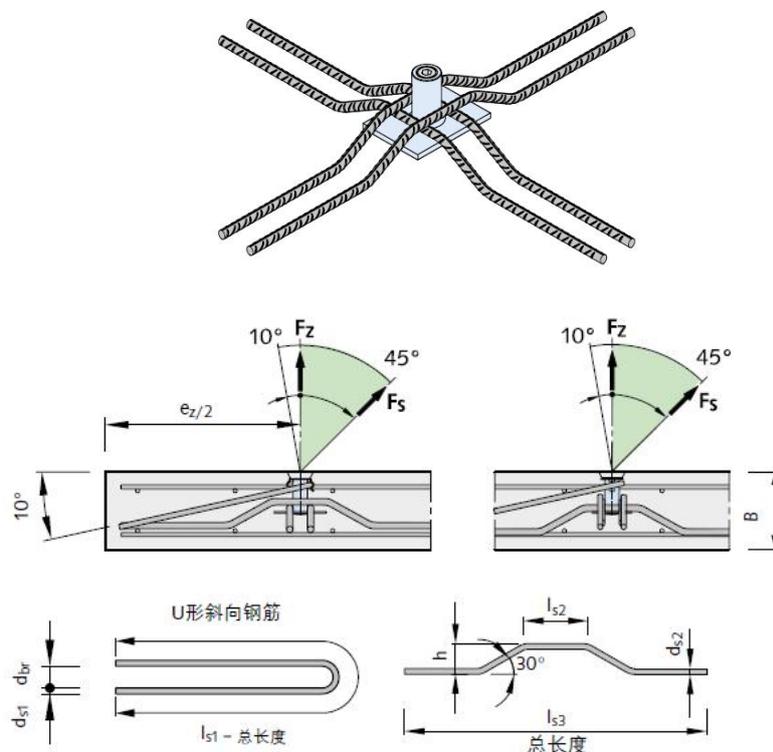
吊钉型吊件附加钢筋设置示意图
